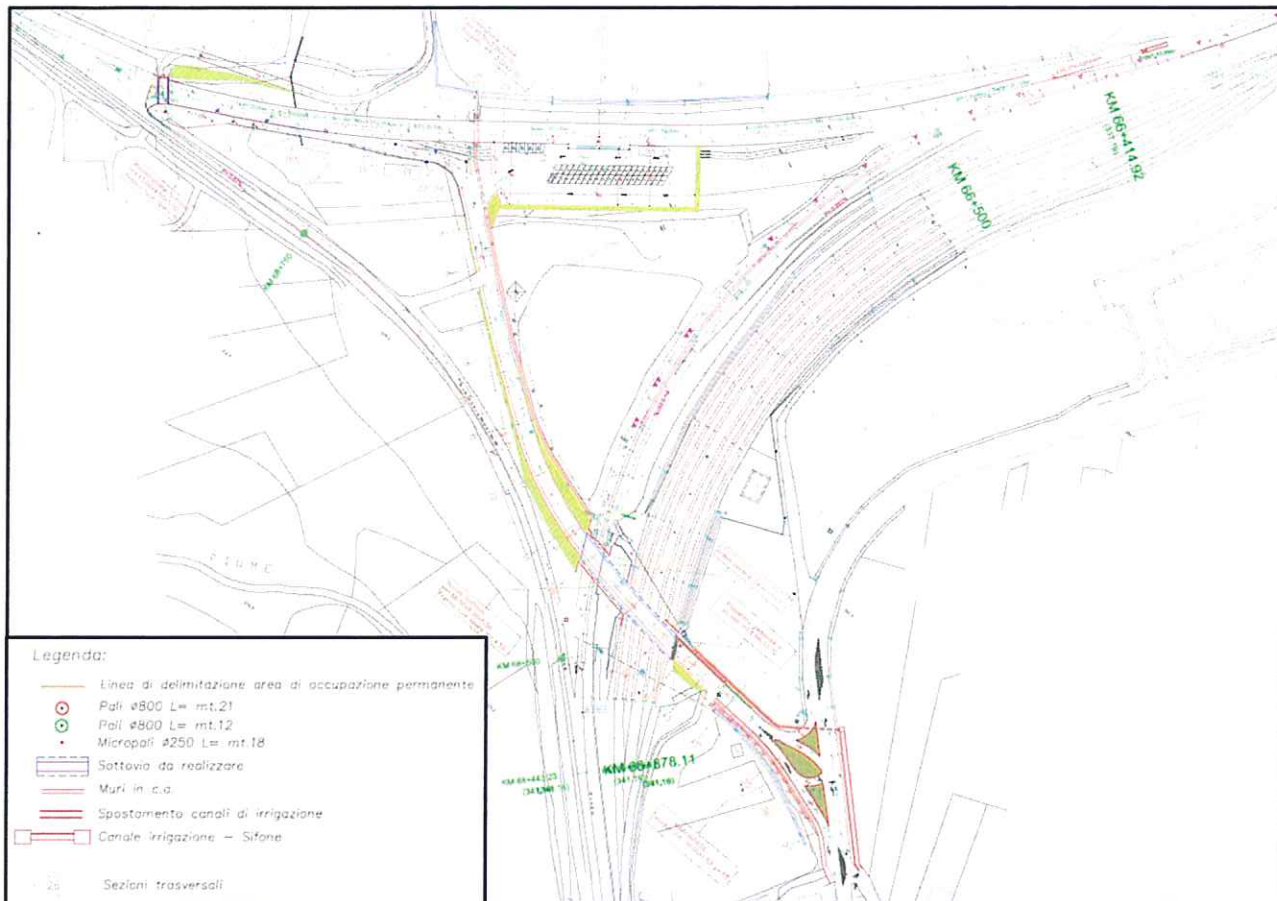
Planimetria stato futuro dell'area di intervento (da Tav. 037 allegata allo SPA).
